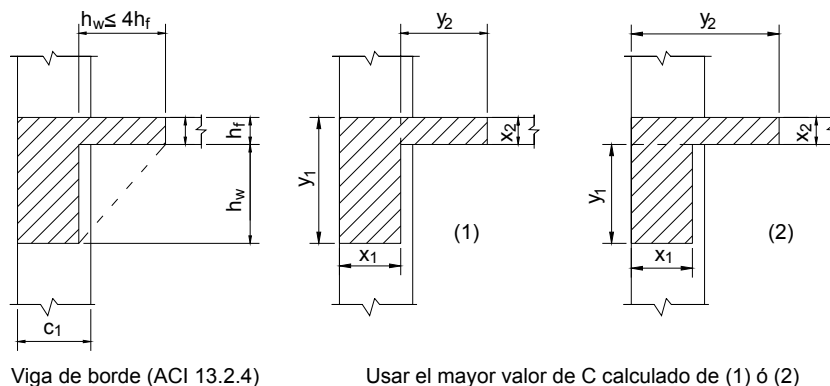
Rigidez de vigas (Vigas de borde)
